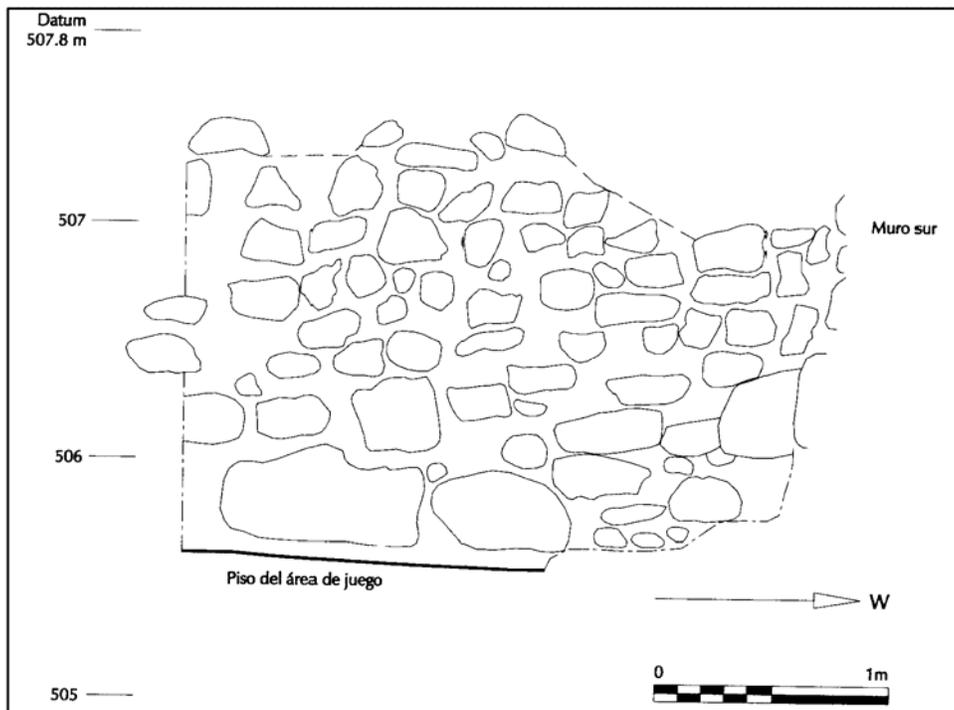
Elevación del muro de piedra en la esquina suroeste, lado interior del patio de juego de pelota
